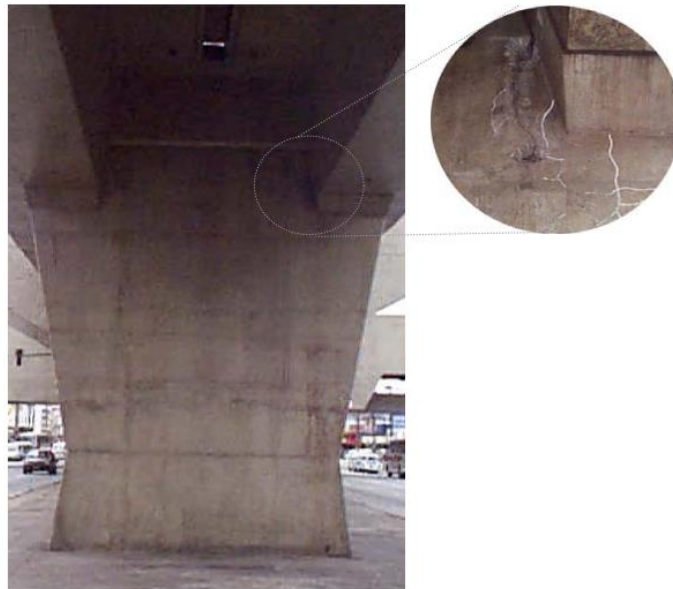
3 Trinca por fadiga em um pilar de uma ponte
